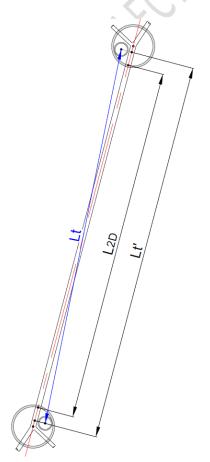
Detalle en planta para el cálculo de la longitud de la tubería.
